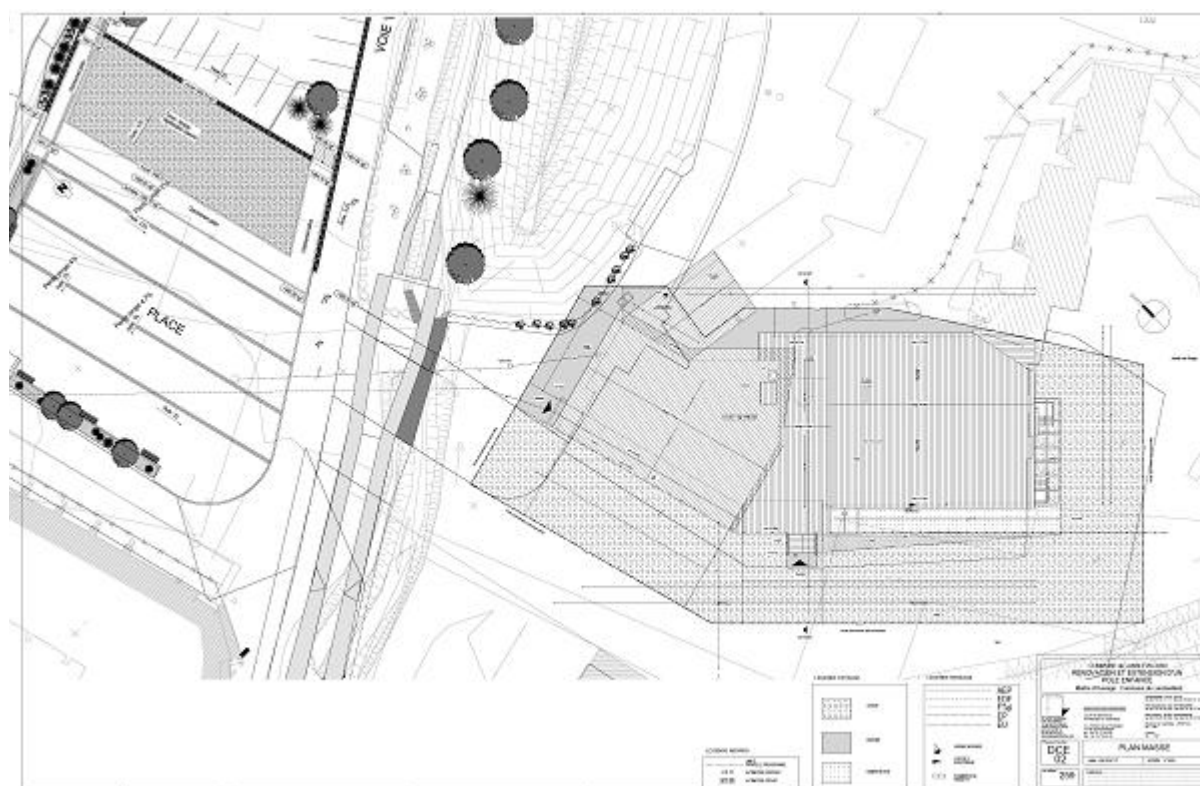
Plan masse de l'extension de la garderie (DE JONG Architecte juillet 2011)
